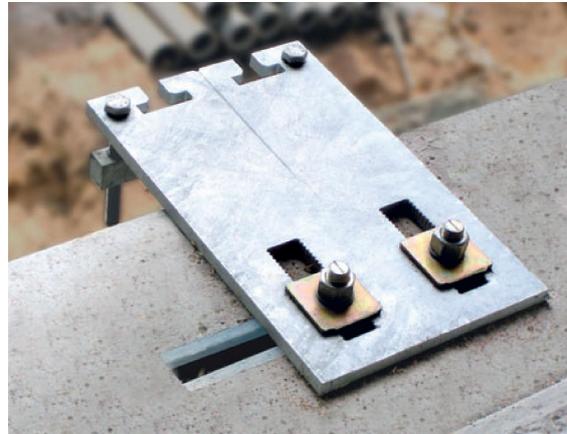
Justierbares Halfen-Verbindungselement zum Fassadenanschluss an eine Betondecke [55]
